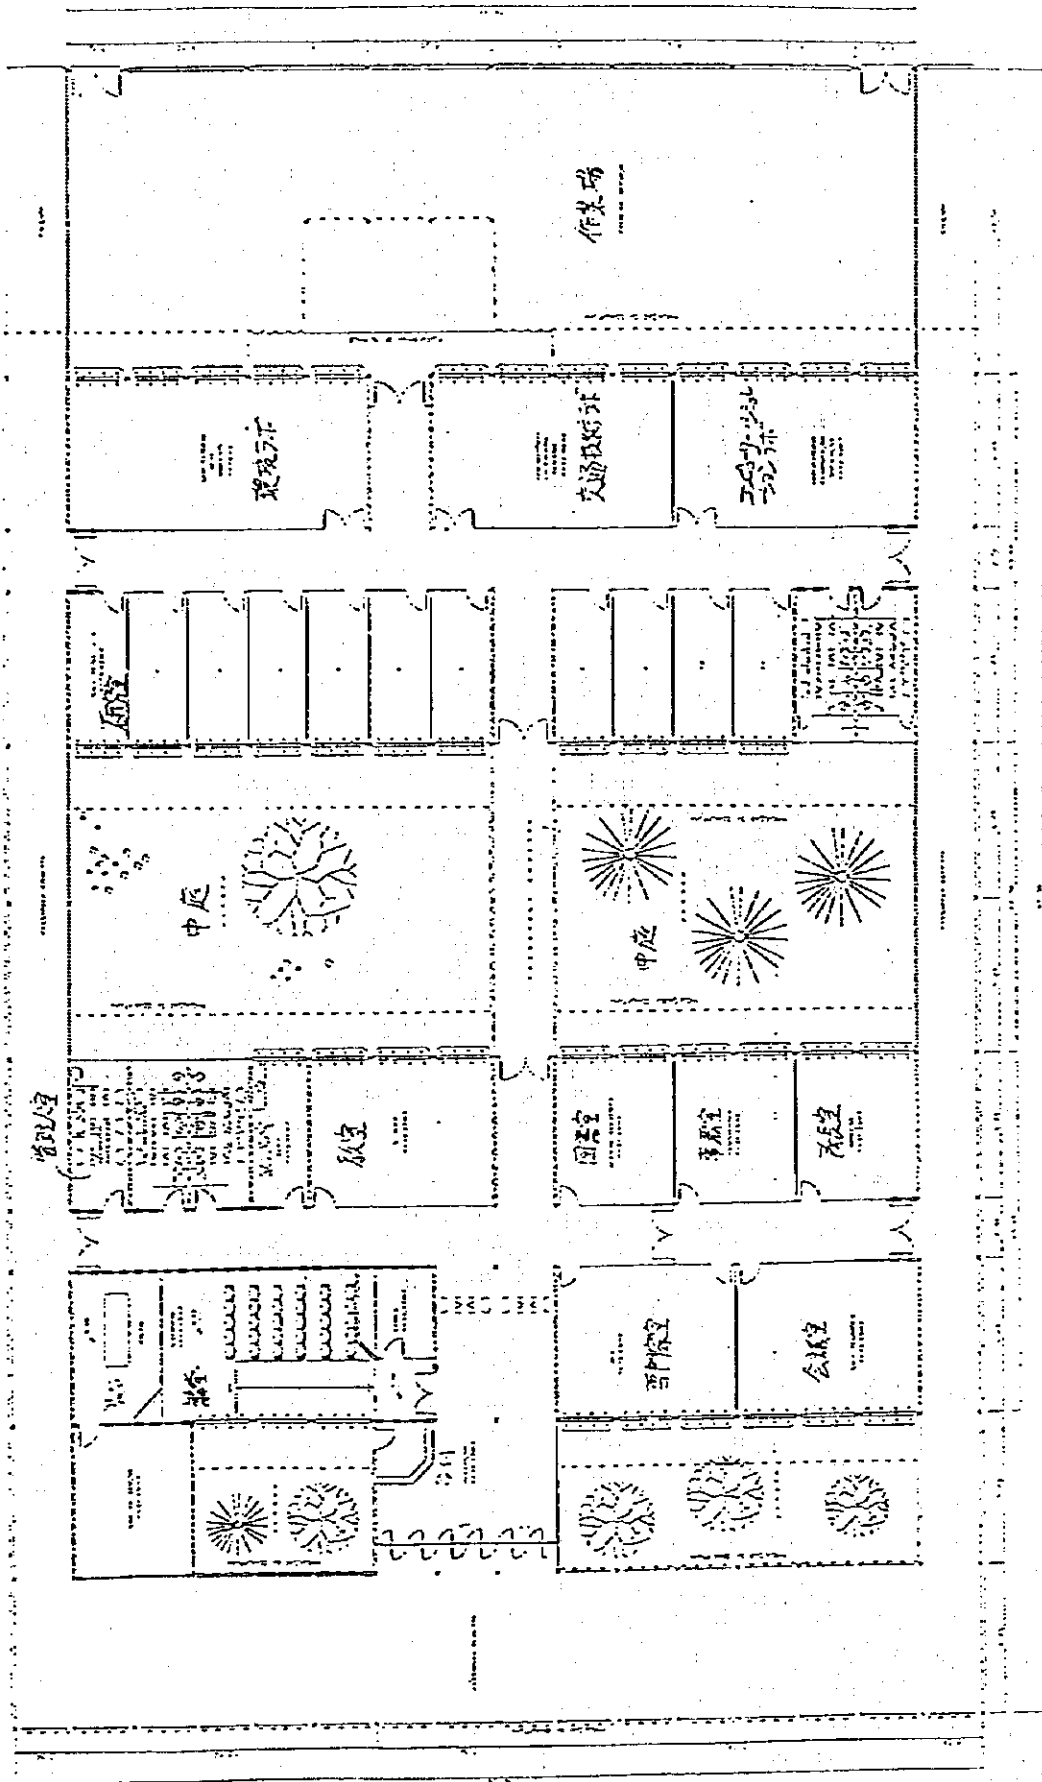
都市交通人材養成センター (CEFTRU) の平面図
